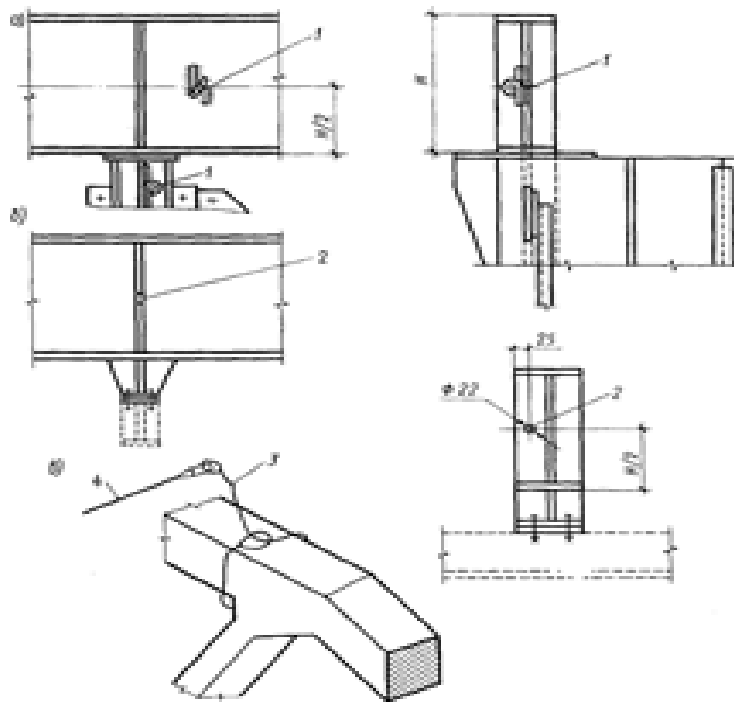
Спеціальні страхувальні пристрої, що забезпечують можливість закріплення карабіном пояса: а, б – при монтажі підкранових балок; в – те ж, залізобетонних ферм; 1 – деталі, приварені до конструкцій; 2 – у вигляді отвору в конструкціях; 3 – подовжувачі стропа пояса; 4 – строп з карабіном пояса, що прикріплюється до подовжувача
